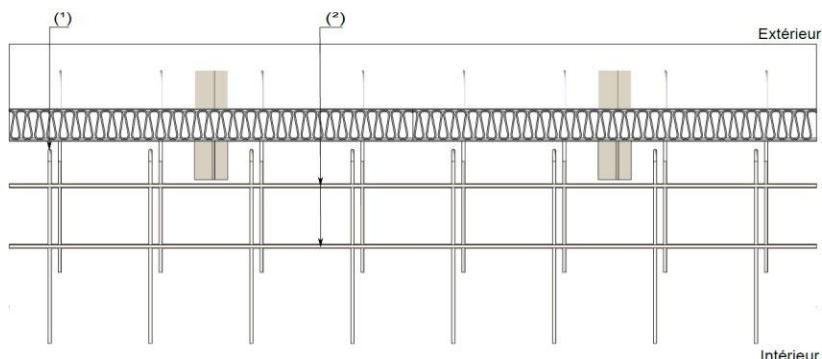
Disposition de chaînage en rive de plancher (vue en plan)
